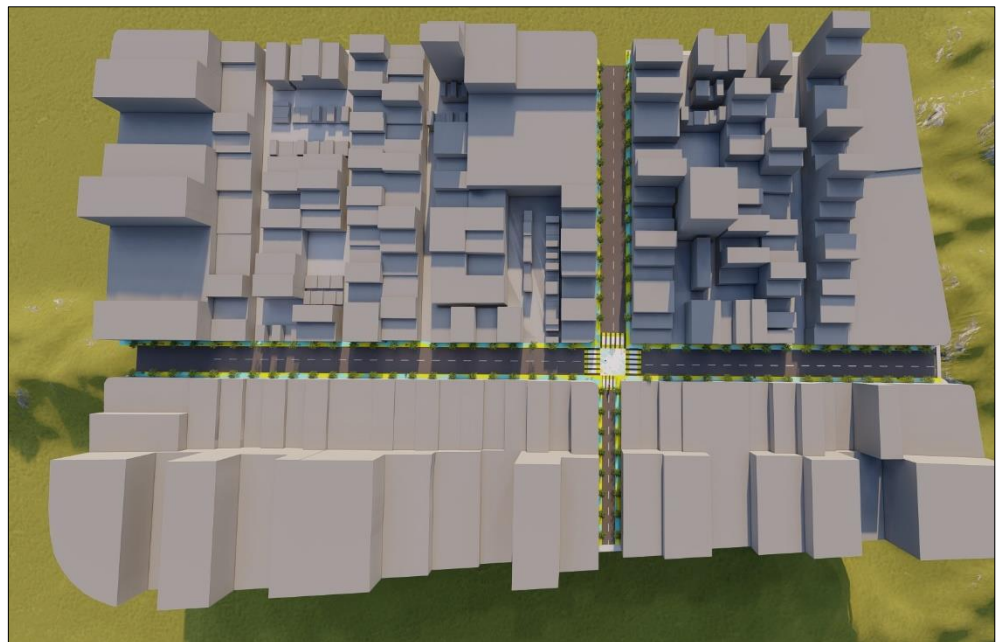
Planta propuesta (AUTORIA PROPIA, 2023)
